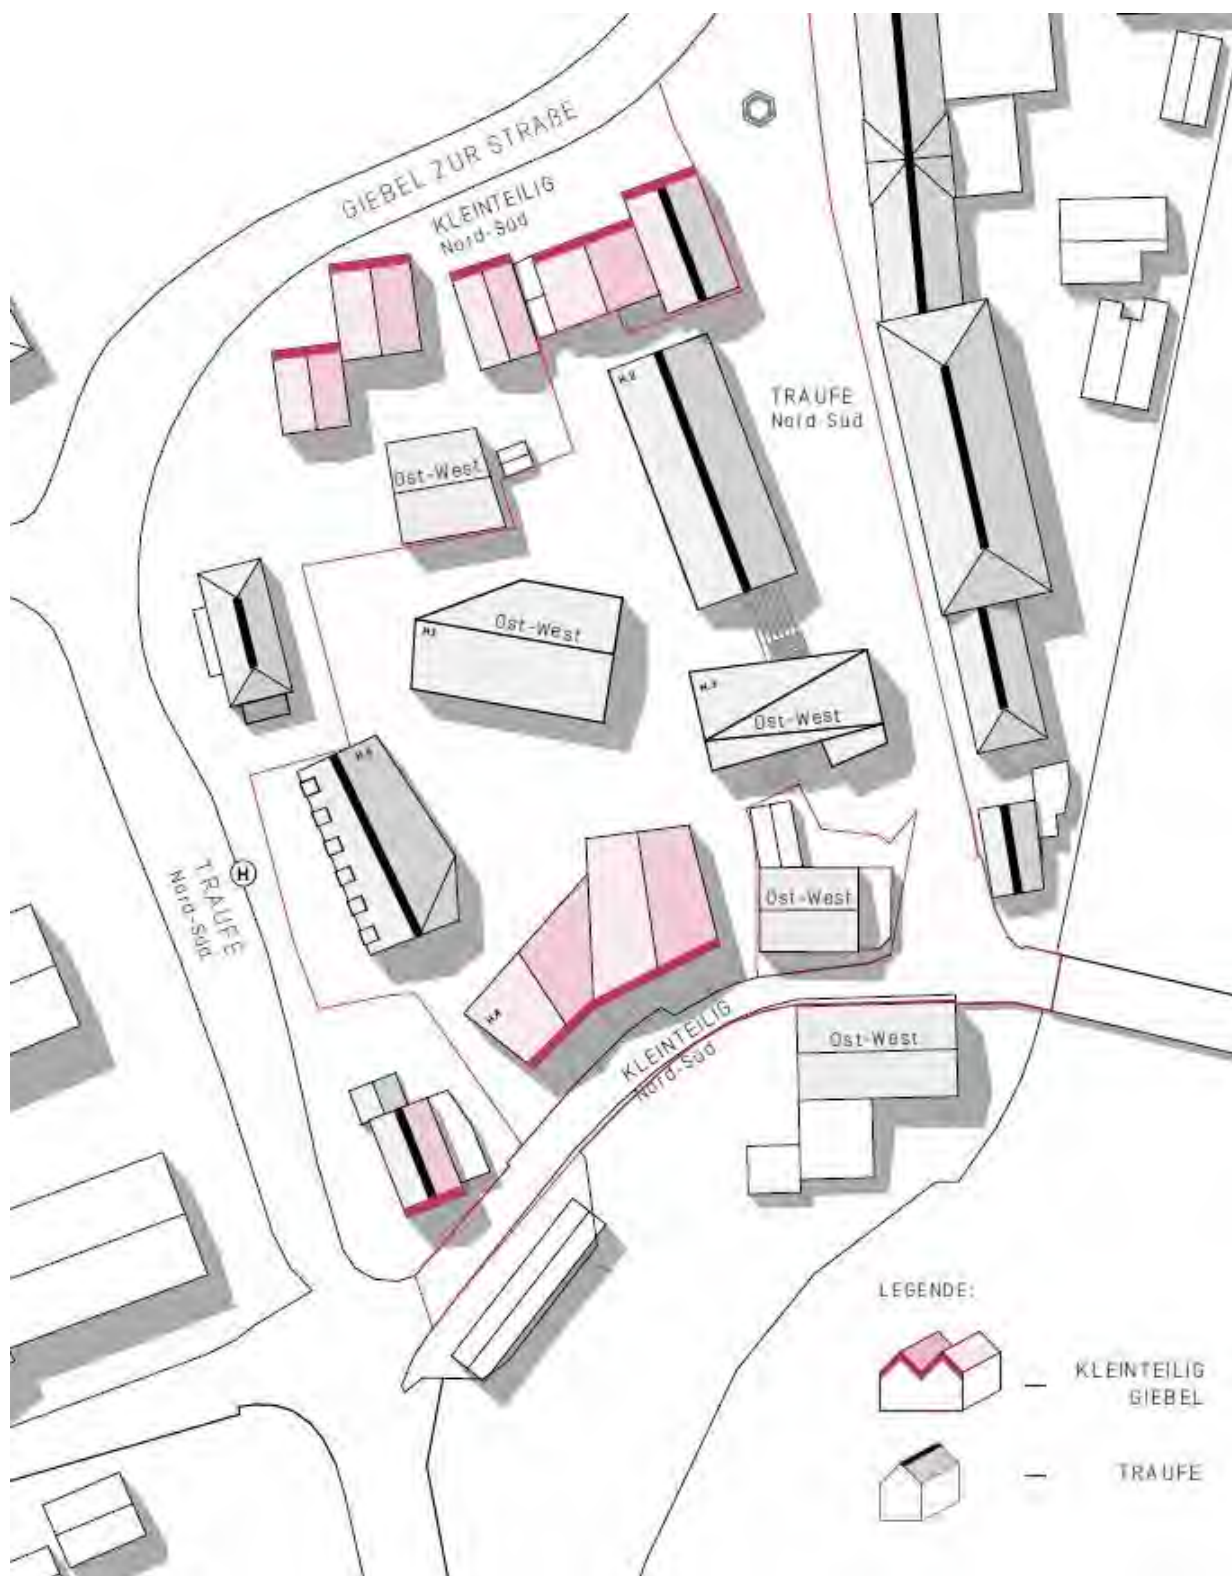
Konzept Dachformen Einbindung - Auszug Wettbewerbsbeitrag, ThalerThaler Architekten
